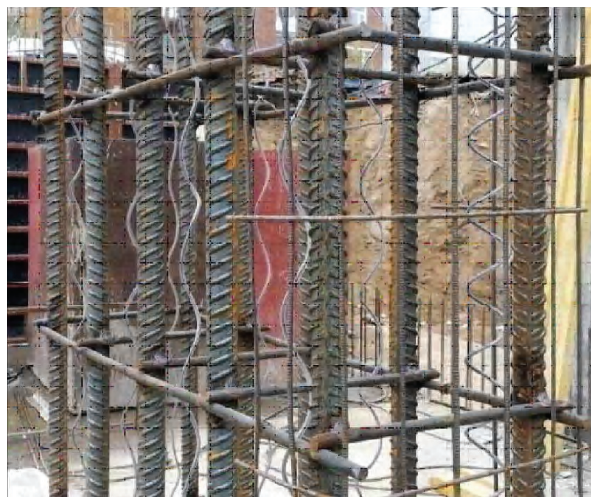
Установка греющего провода вдоль арматуры на всю высоту колонны.
